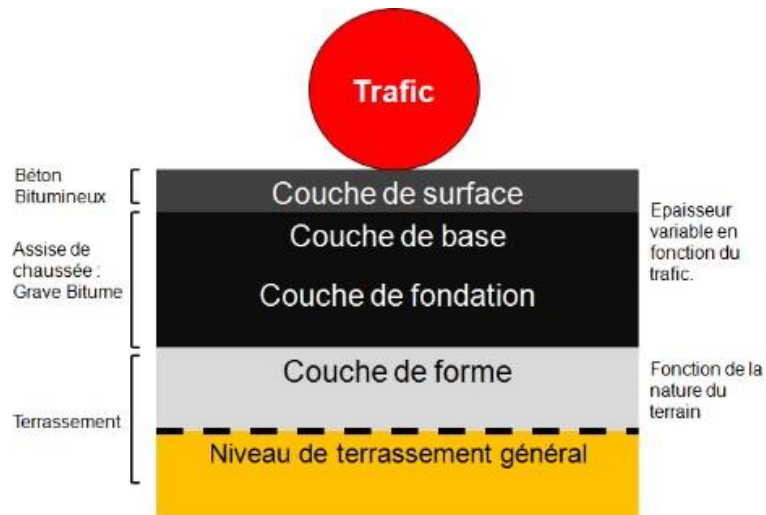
Structure d'une chaussée bitumineuse épaisse.
